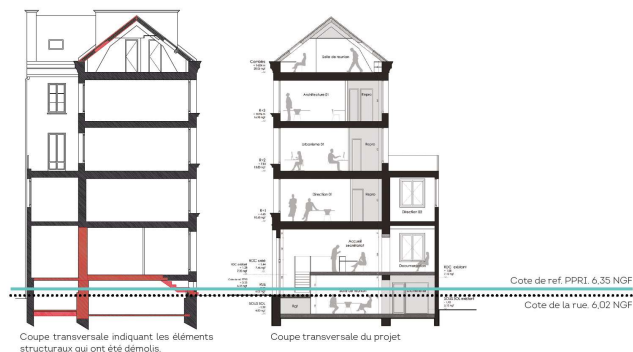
coupe transversale du projet de restructuration du C.a.u.e.
